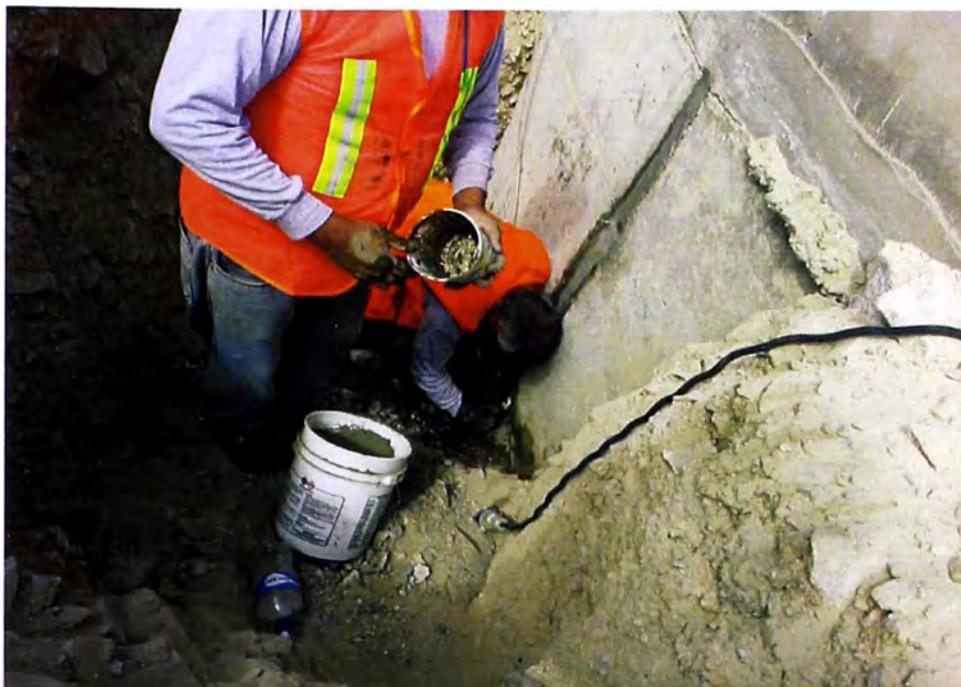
Colocación de la mezcla del mortero de fraguado rápido, a lo largo de la junta para sellarla superficialmente.
